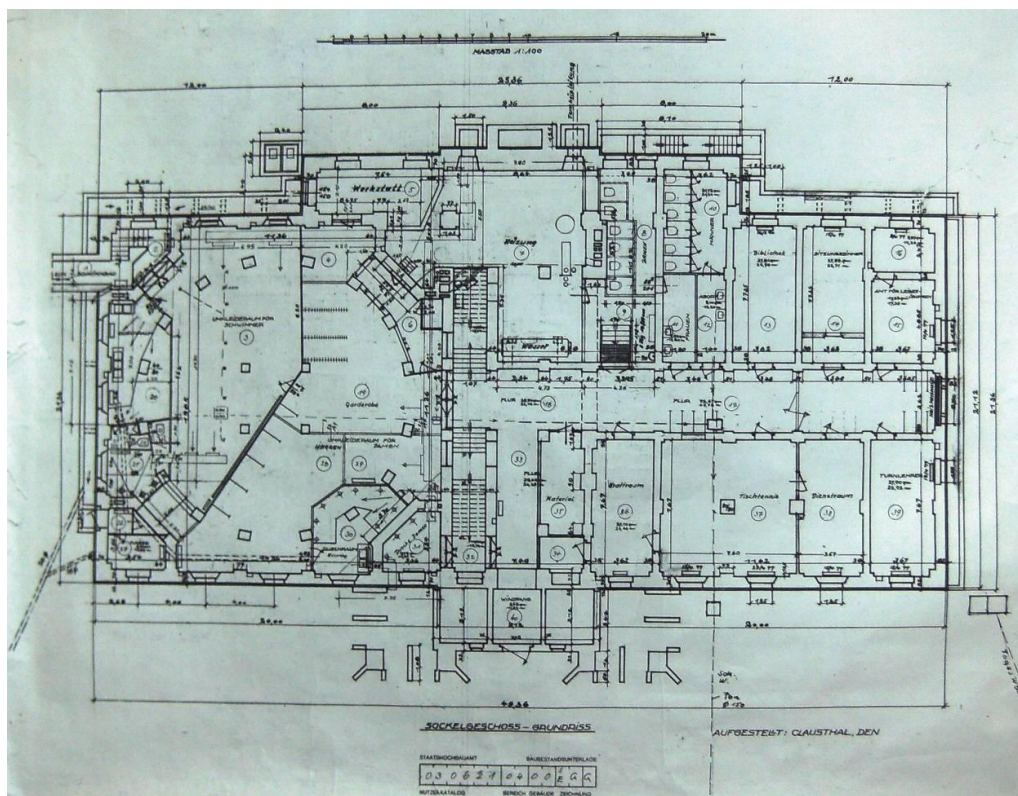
Aula und Turnhalle. Grundriss des Sockelgeschosses.
